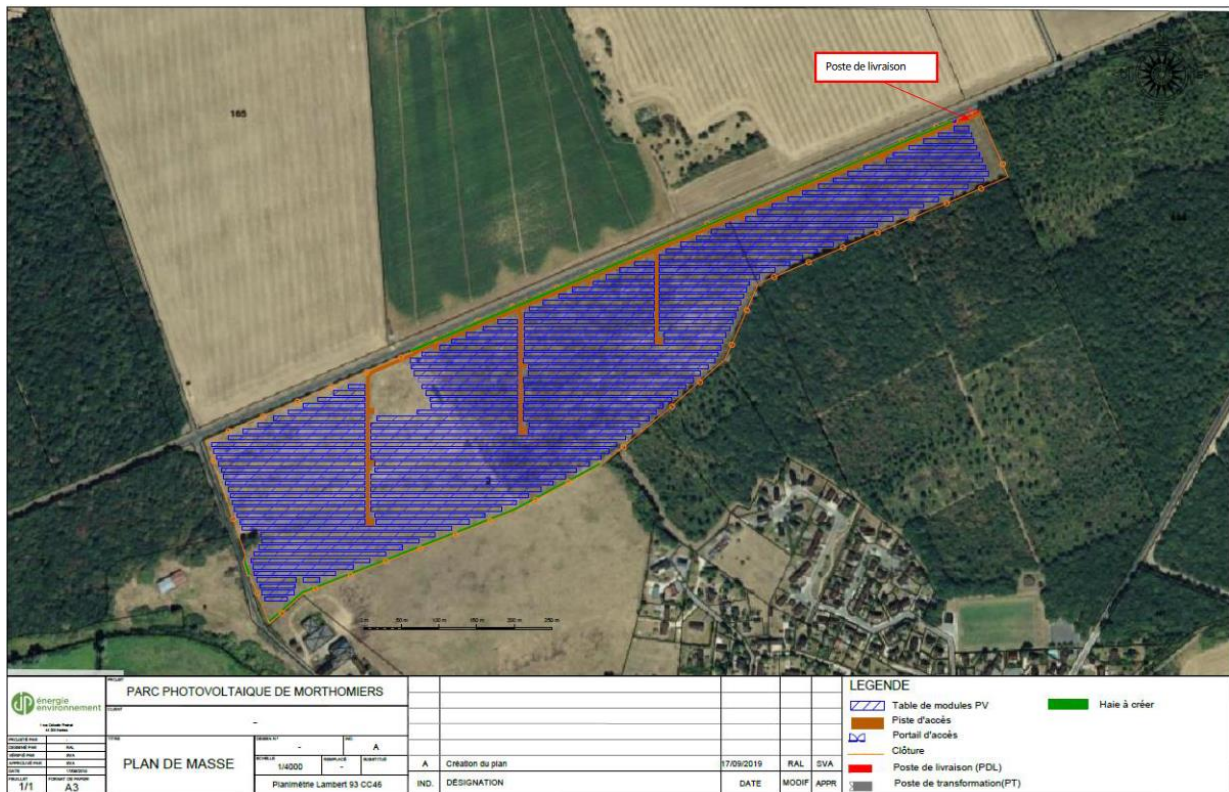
Plan de masse du parc photovoltaïque (source : JPEE)
